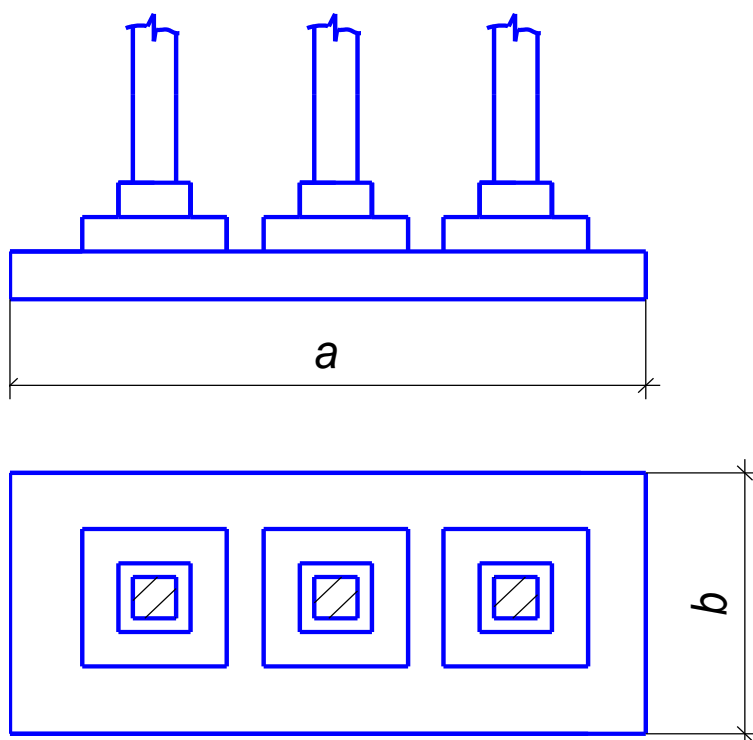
Схема стрічкового фундаменту під опору стояк шляхопроводу.
